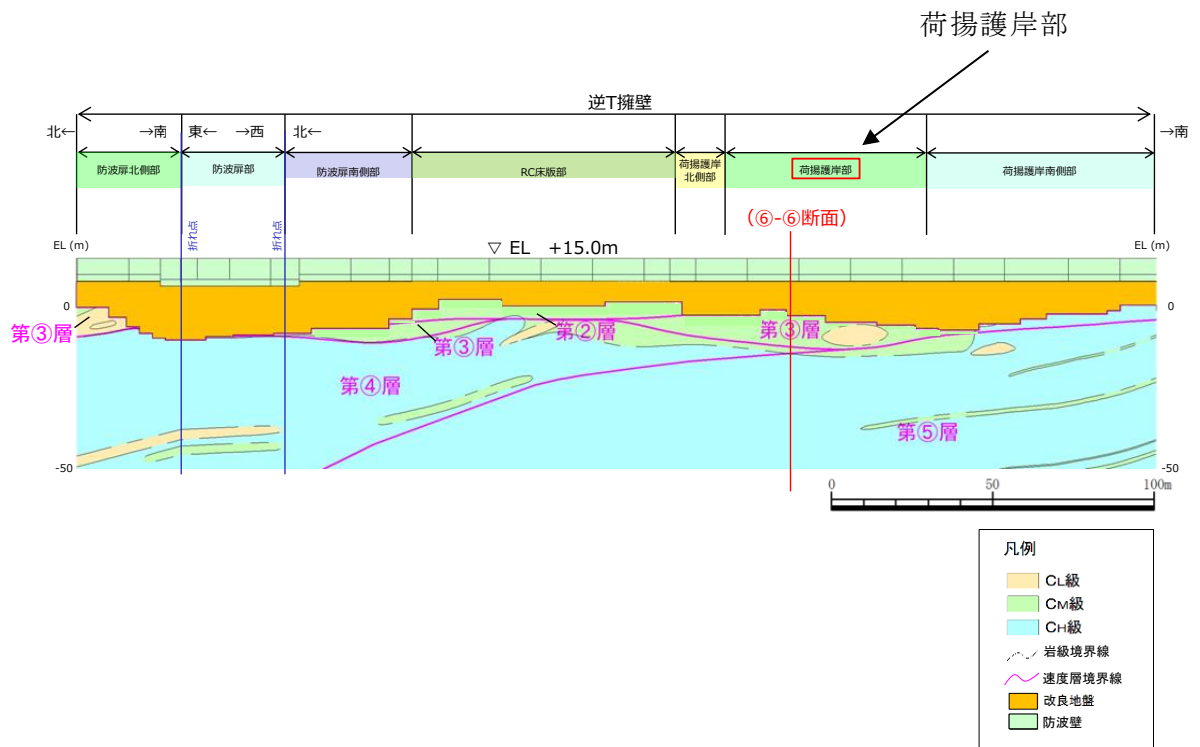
(1) 防波壁（逆 T 擁壁）の地質縦断面図（岩級図）
